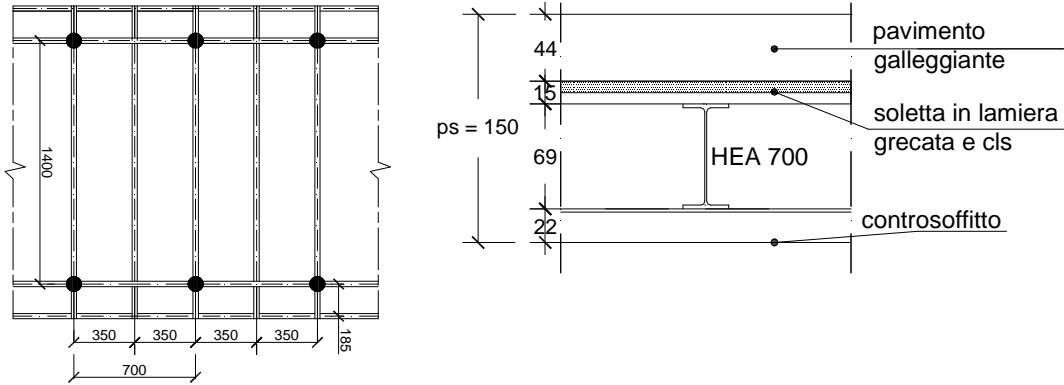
soluzione n.°1 in acciaio, pianta di piano e sezione impalcato
